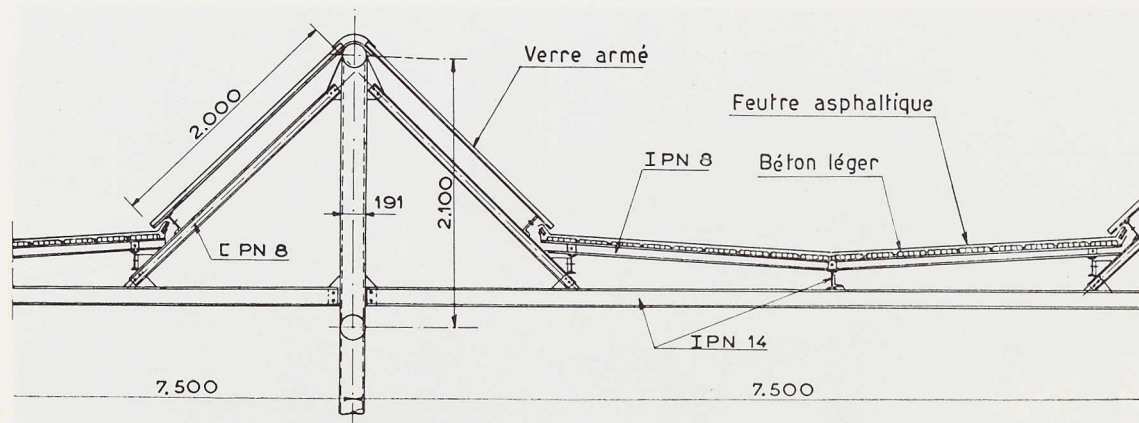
Coupe transversale de la toiture dont la charpente est constituée par des fermes en treillis tubulaire.
